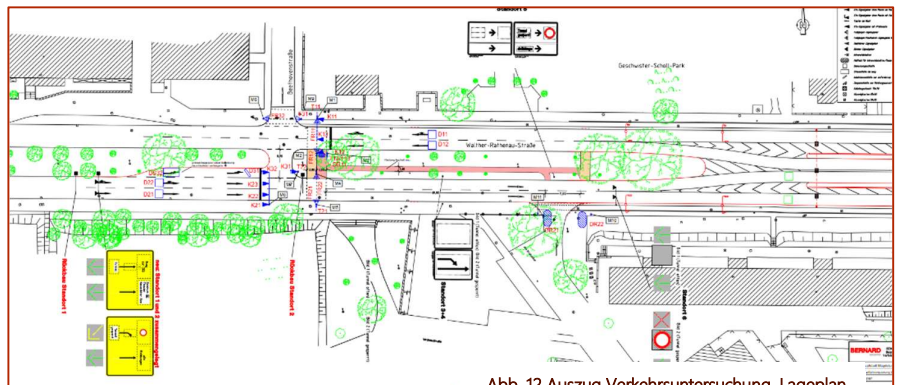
Auszug Verkehrsuntersuchung, Lageplan
